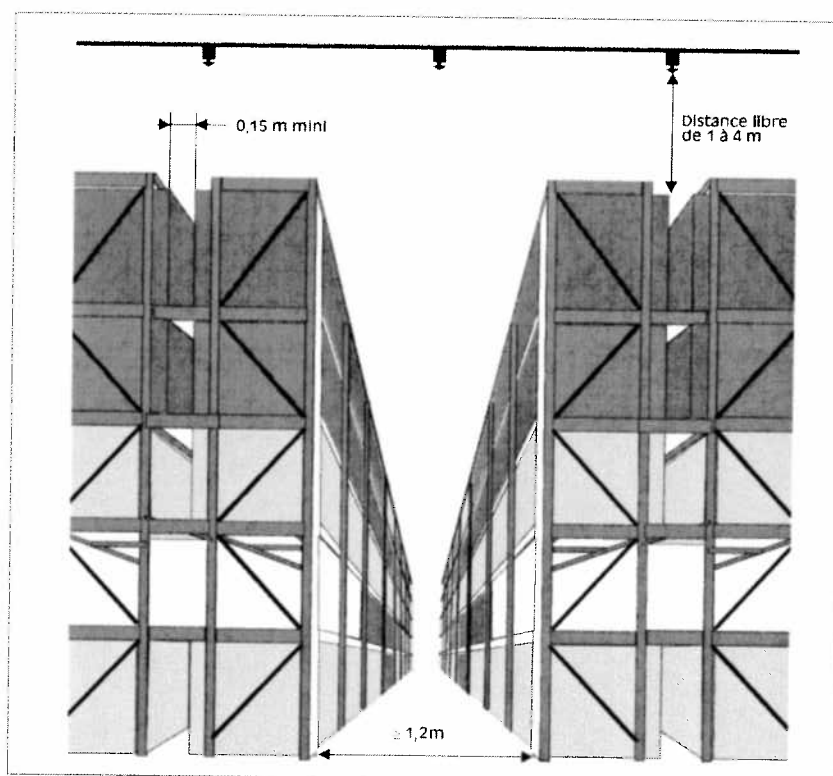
α : Stockage ST4 - palettes sur racks
